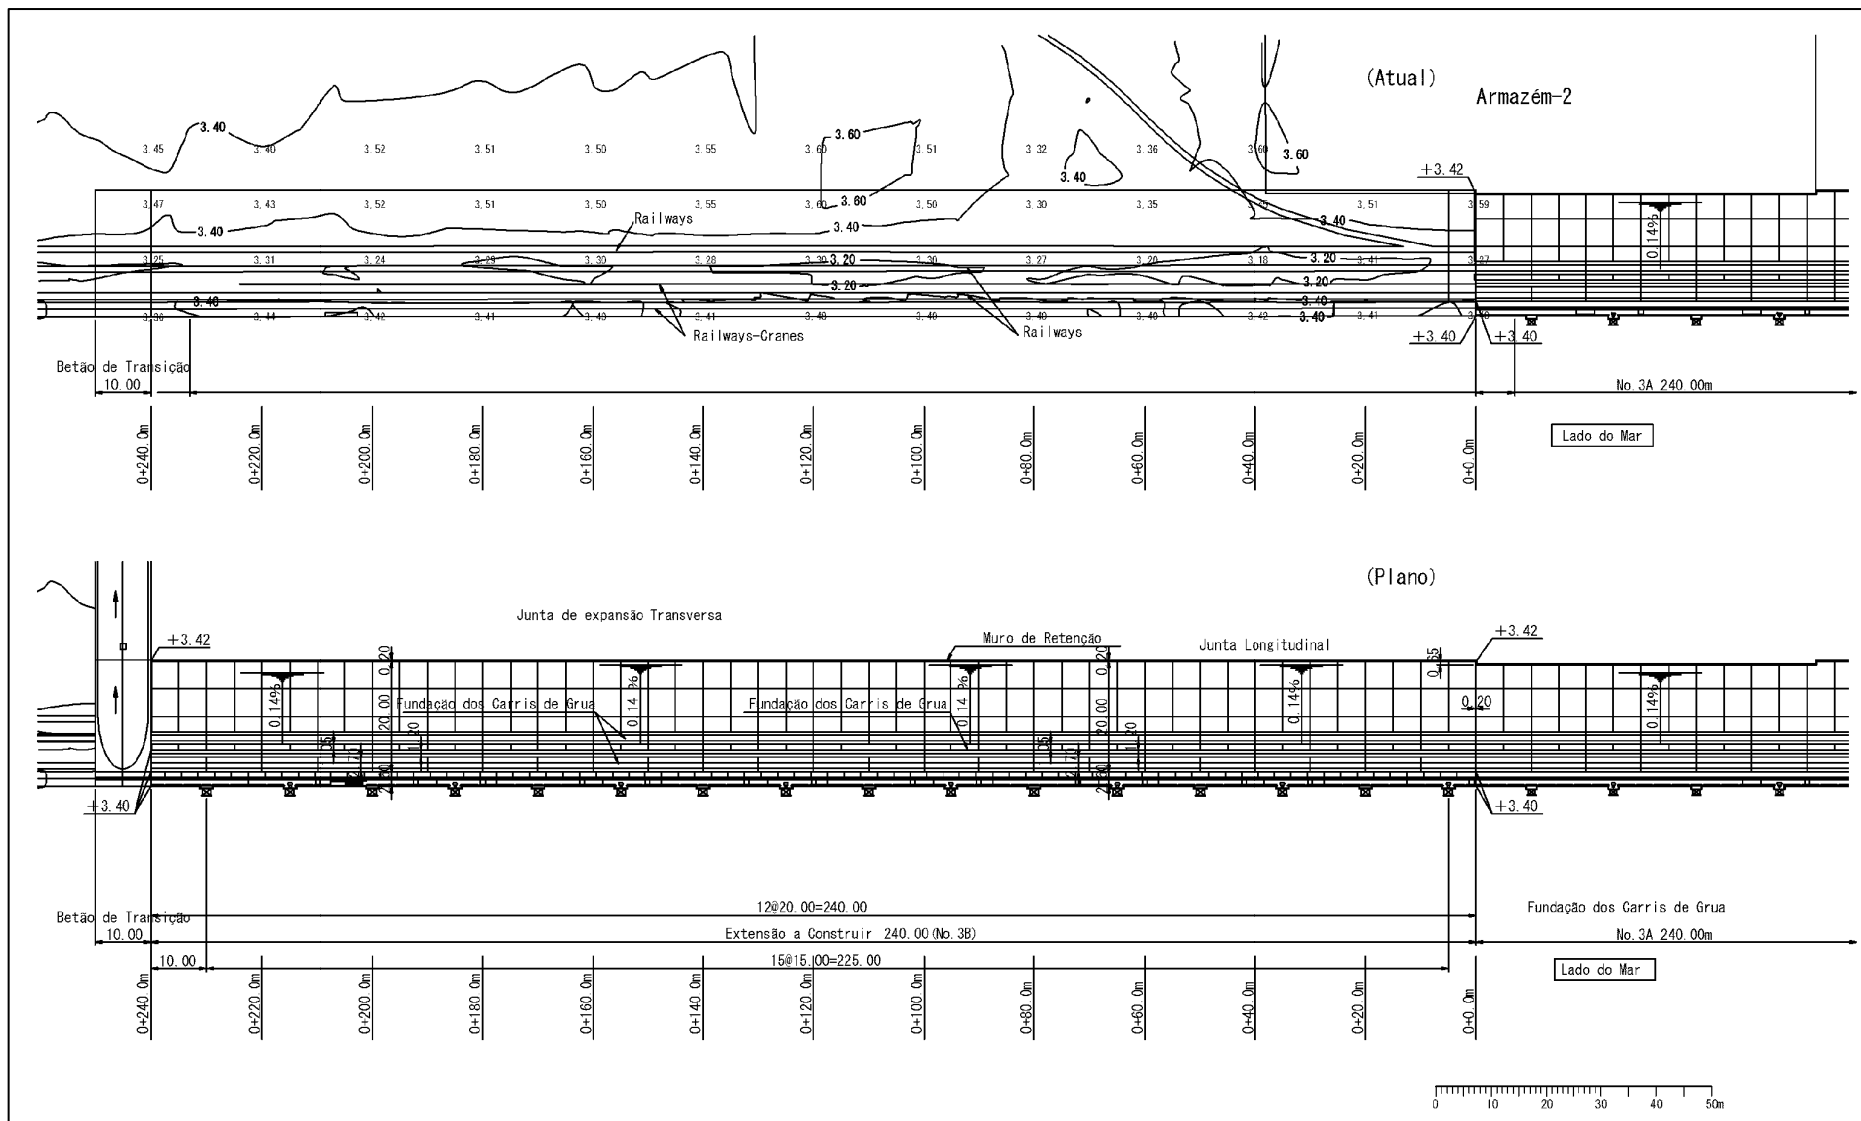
Planta Planimétrica da Pavimentação do Cais
